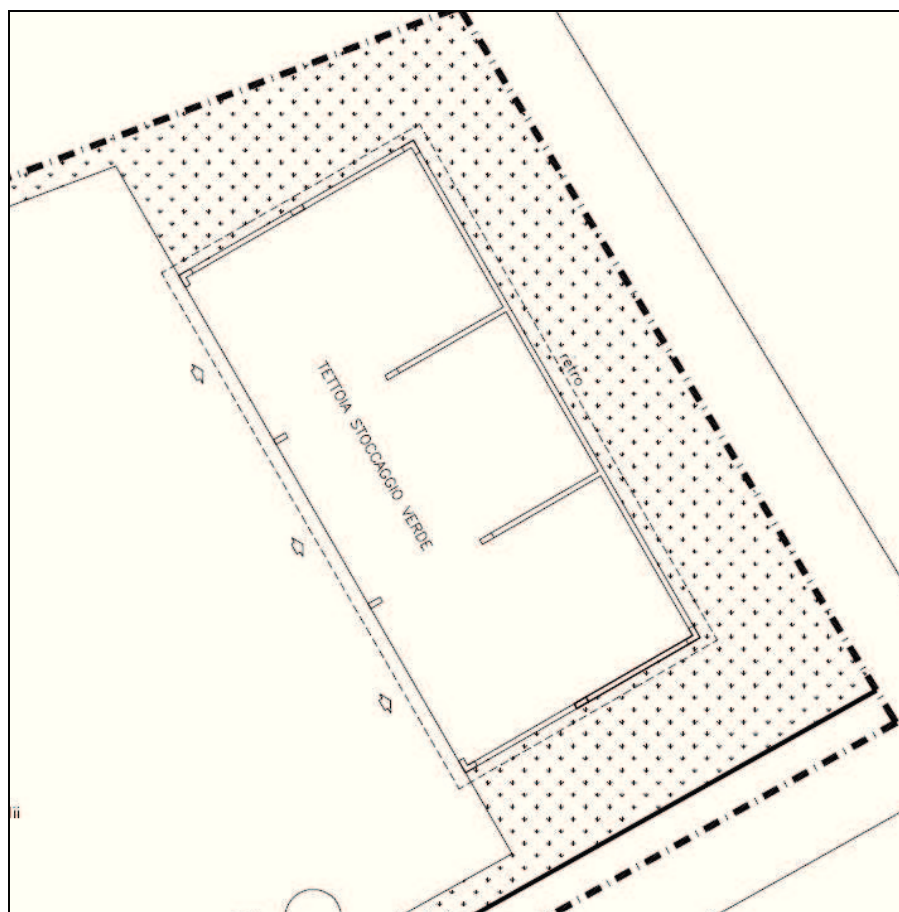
Stralcio planimetrico con ubicazione della tettoia per lo stoccaggio di legno e verde
